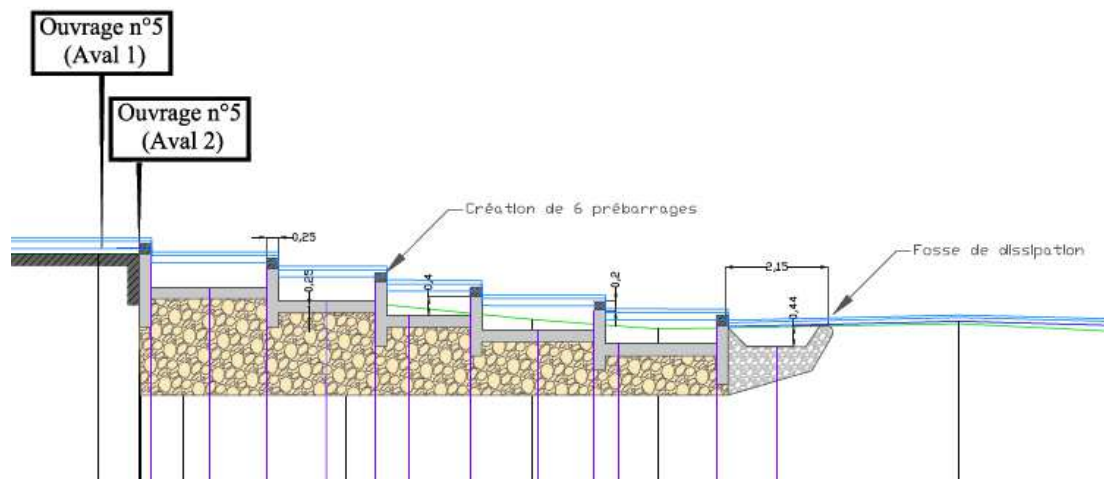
Extraits de plan de faisabilité – OH4 et OH5
